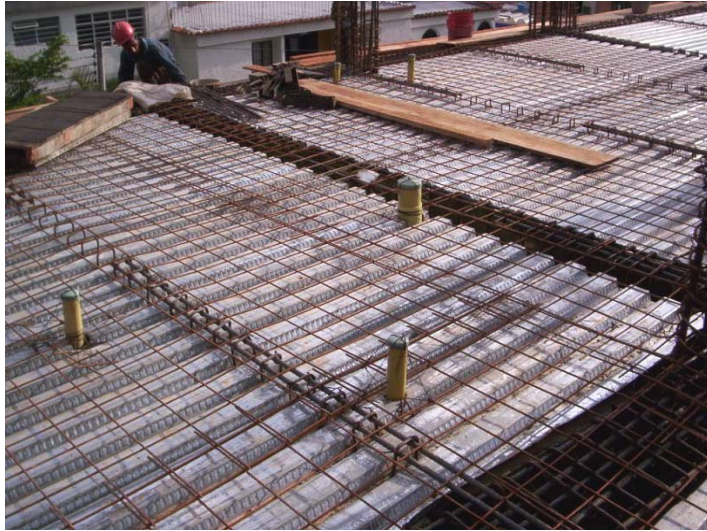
Detalle separación entre conectores (Dos Puntos de Soldadura E-6013).
